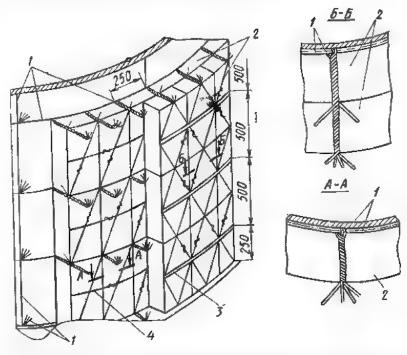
Изоляция оборудования жесткими изделиями на стижках:
